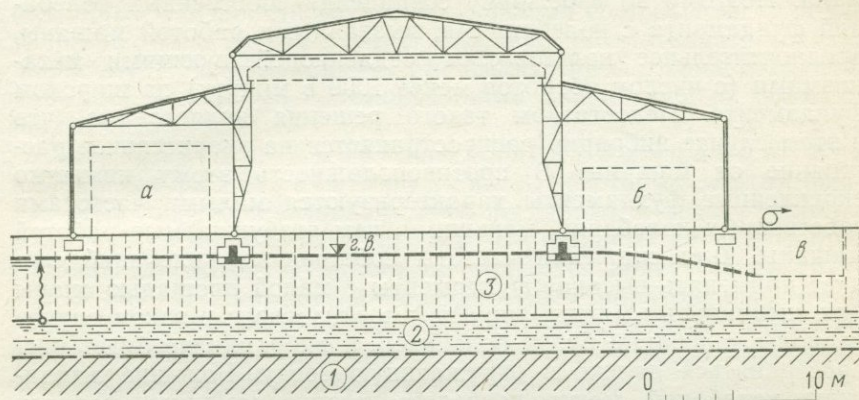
Дополнительная осадка фундаментов литейного корпуса, вызванная высыханием грунта под плавильной печью.
